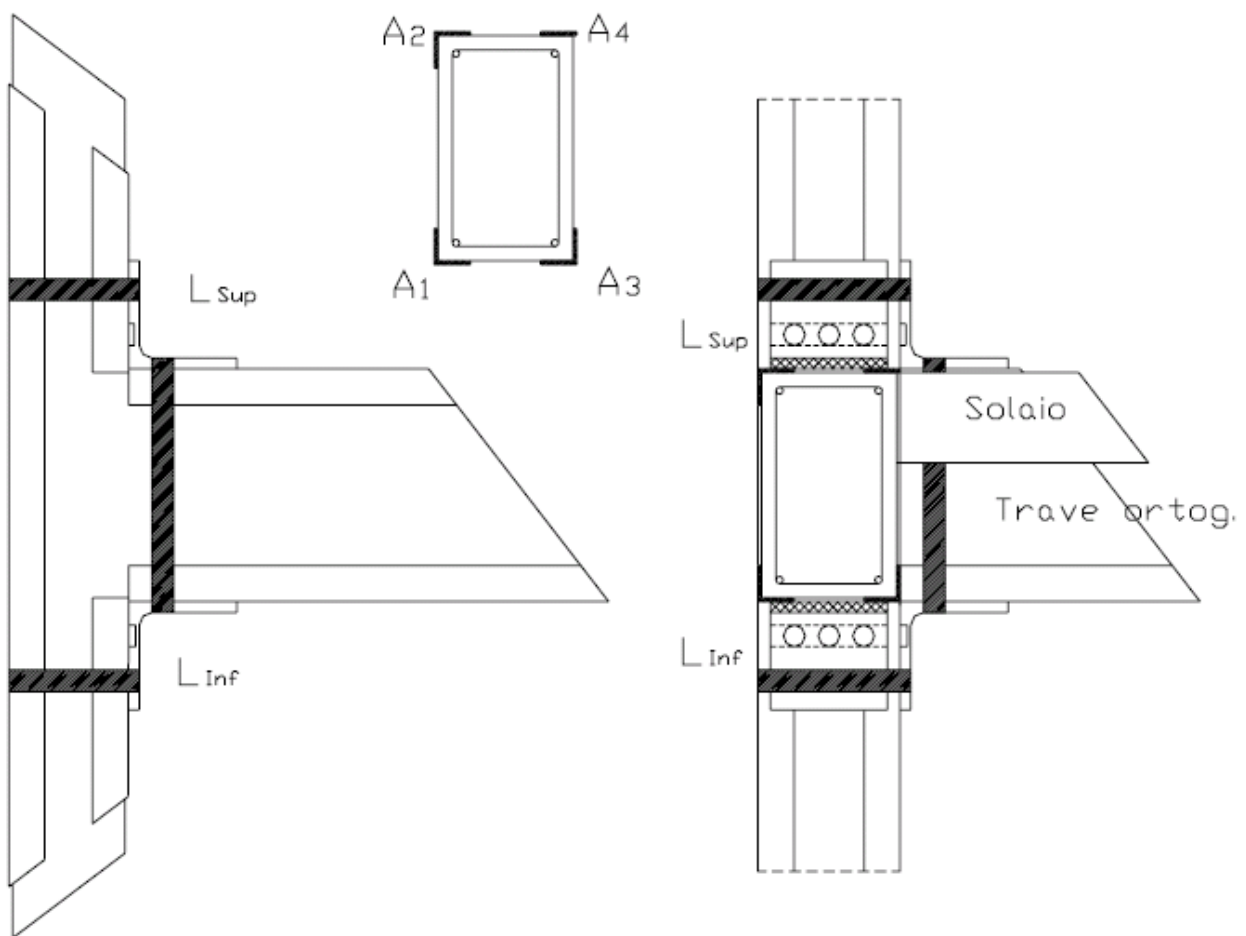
Schema applicazione angolari dissipativi in corrispondenza del nodo trave - pilastro
